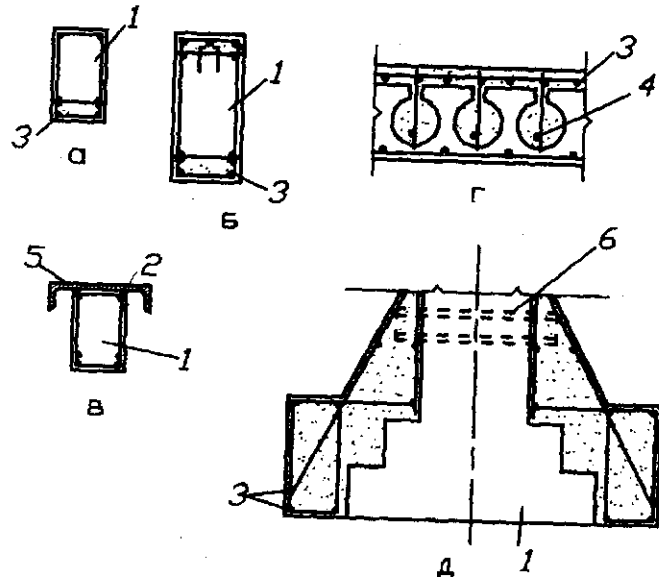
Усиление железобетонных конструкций: а, б, в, д — набетонкой и дополнительным армированием; г — прикреплением швеллера через коротыши; 1 — усиливаемая конструкция; 2 — коротыши из арматуры; 3 — арматура набетонки; 4 — каркас; 5 — швеллер; 6 — траверса
